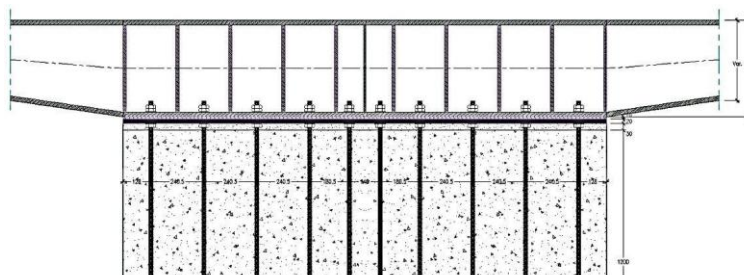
Geometria das carlingas extremas e ligação aos pilares de betão armado
